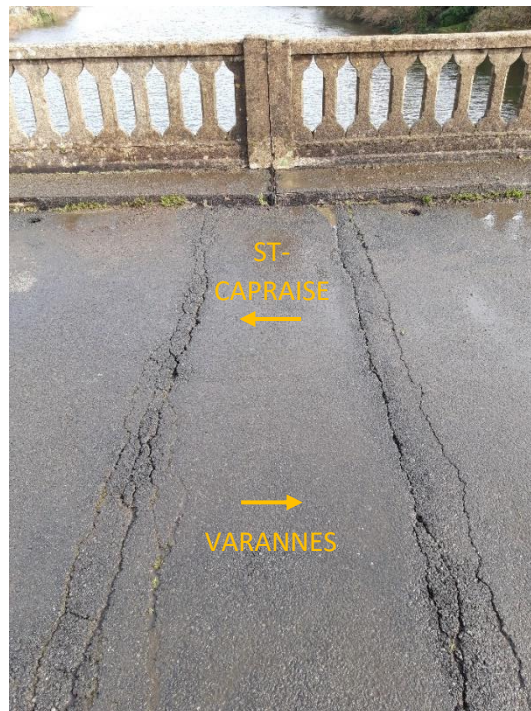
Etat de la chaussée au droit des dalles [Photo DIADES]
